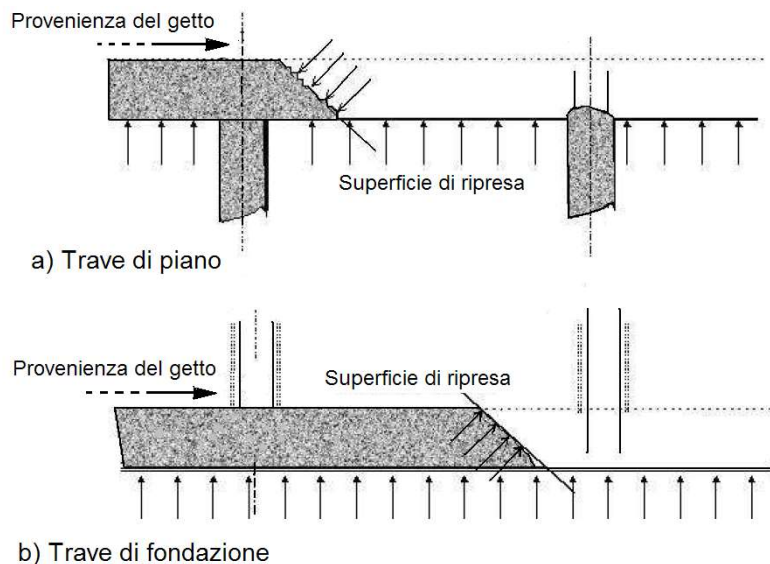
Modalità di ripresa del getto in travi di piano e di fondazione
